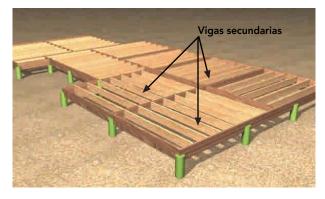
27: Entramado de piso dispuesto sobre sistemas de fundaciones aisladas. Conformado por vigas maestras o principales y vigas secundarias que recepcionan los tableros estructurales arriostrantes y base para la solución de piso.
